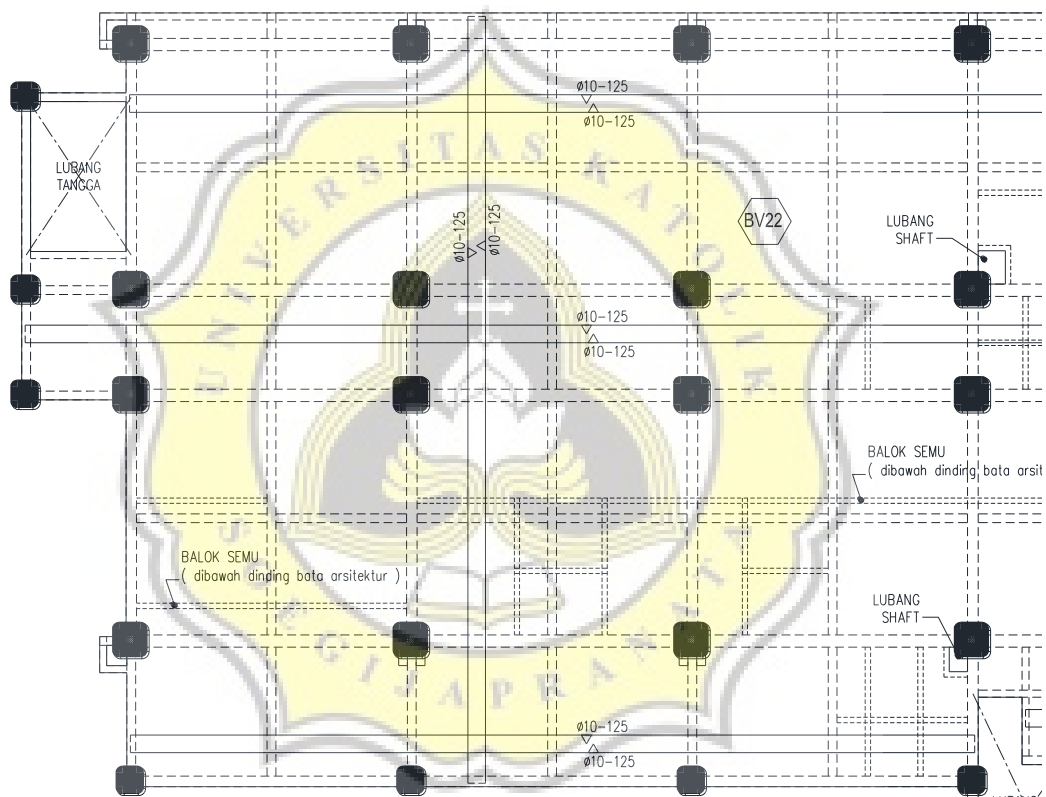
Detail Sambungan Lewatan Plat Bentang Pendek
